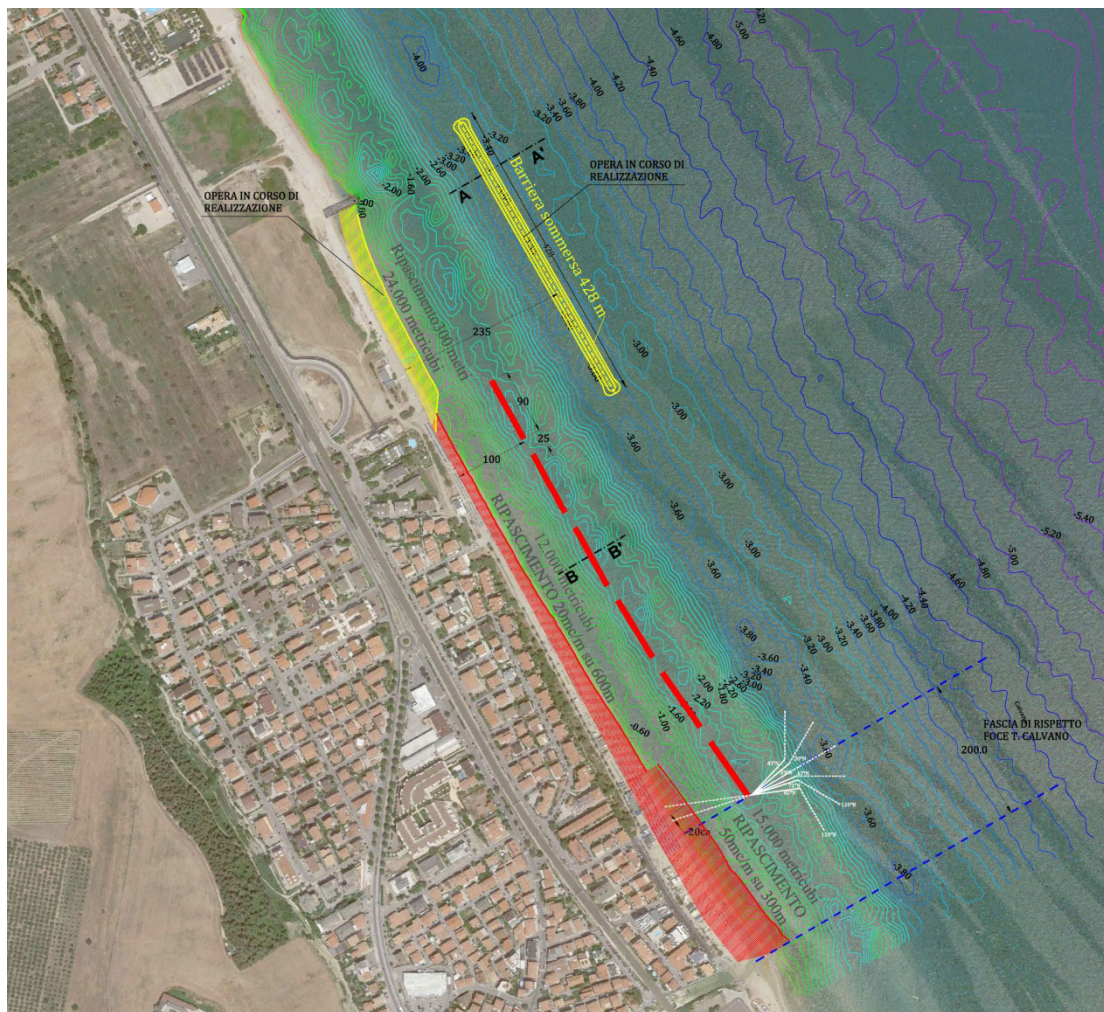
Planimetria intervento - soluzione 1 - scogliere foranee e ripascimento
